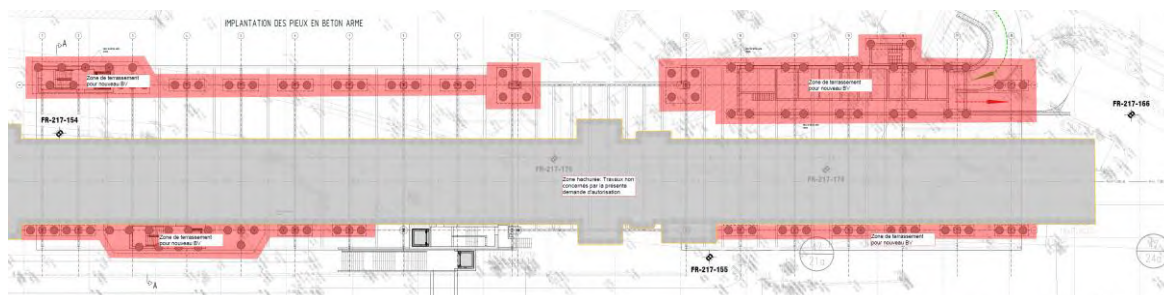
Vue en plan terrassement / fondations « Park & Ride »
